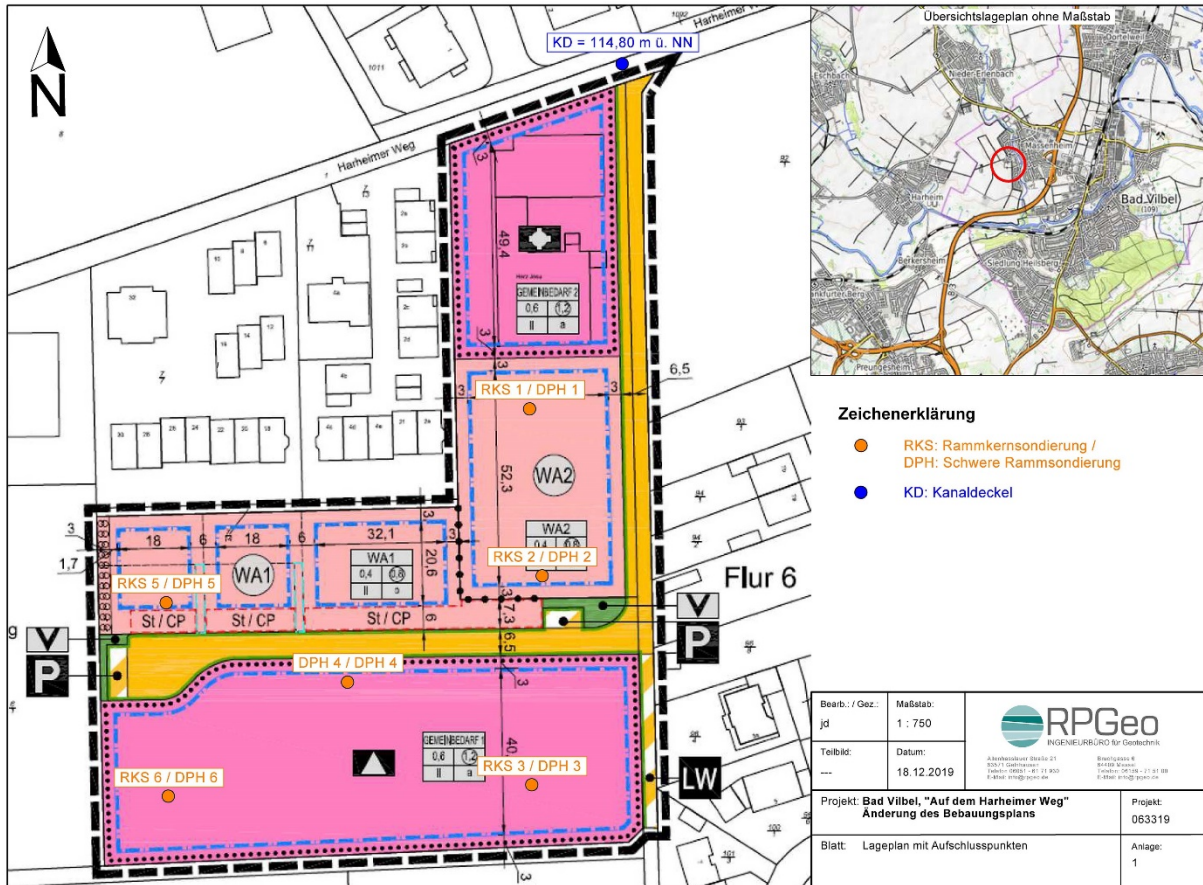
Lageplan mit Aufschlusspunkten<sup>9</sup>
